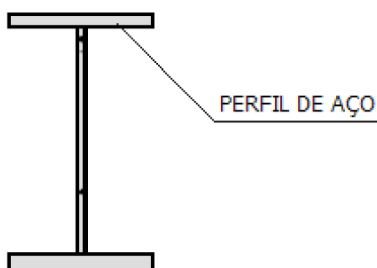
Seção resistente da viga mista antes da cura do concreto da laje.
